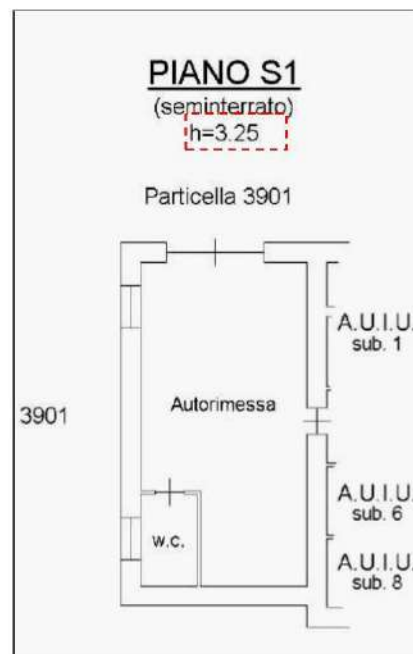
Planimetria castale Autorimessa comune (Sub. 2)
